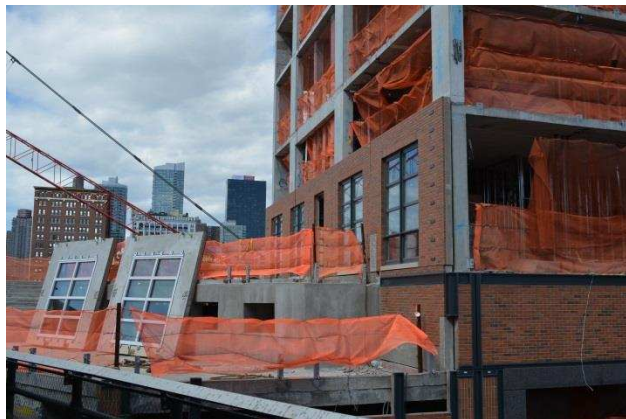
Fachada constituída por painéis pré-fabricados de concreto. (ISSAC, 2016)
